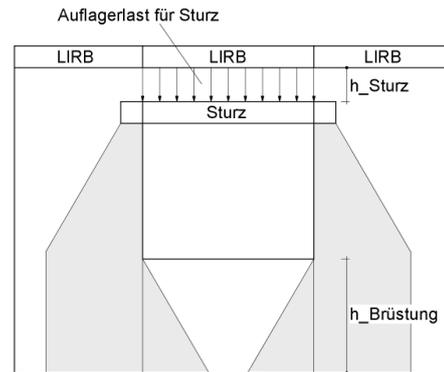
Lastübergabe bei Wandabschnitt mit Aussparung
